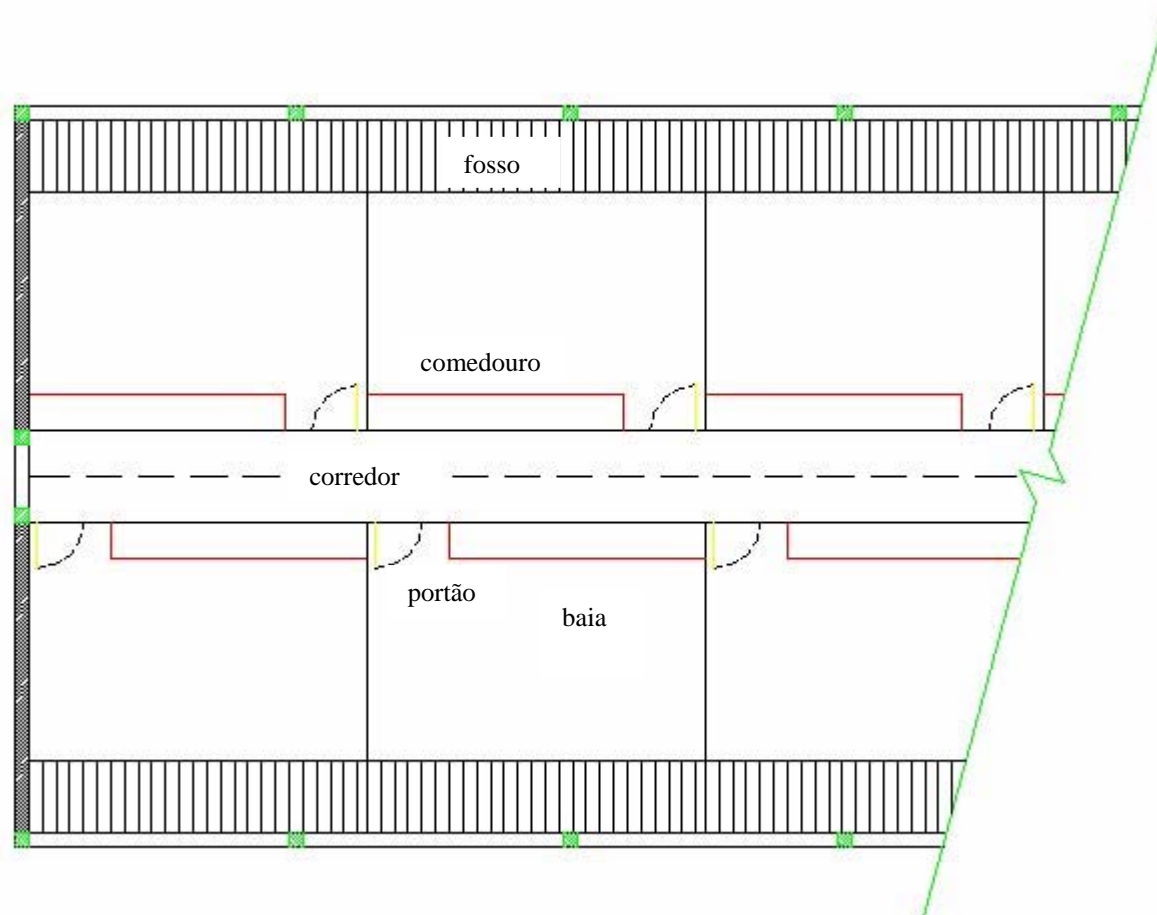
esquema em planta baixa de um prédio com baias coletivas, possíveis de se usar para animais em crescimento e porcas em gestação
